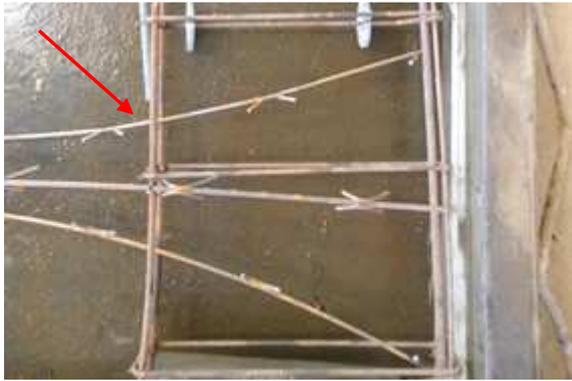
Corte da senoide da treliça e amarração junto à armadura da viga.
